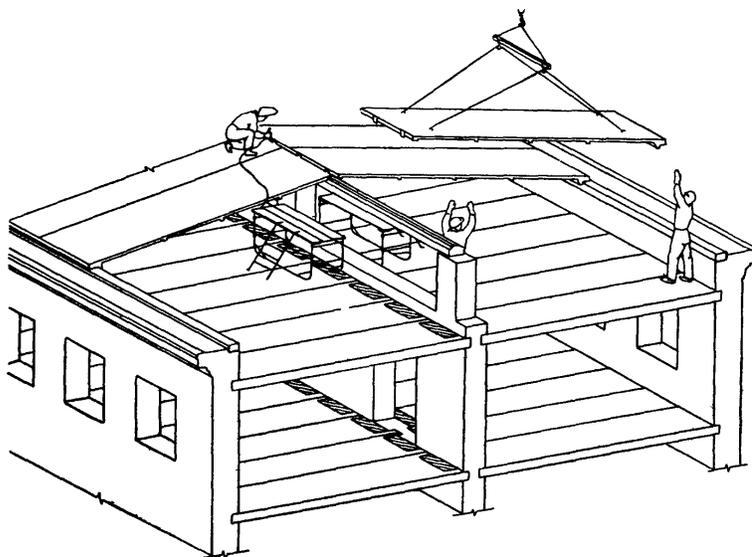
Общая схема организации работ по монтажу участка крыши из железобетонных панелей ПР
